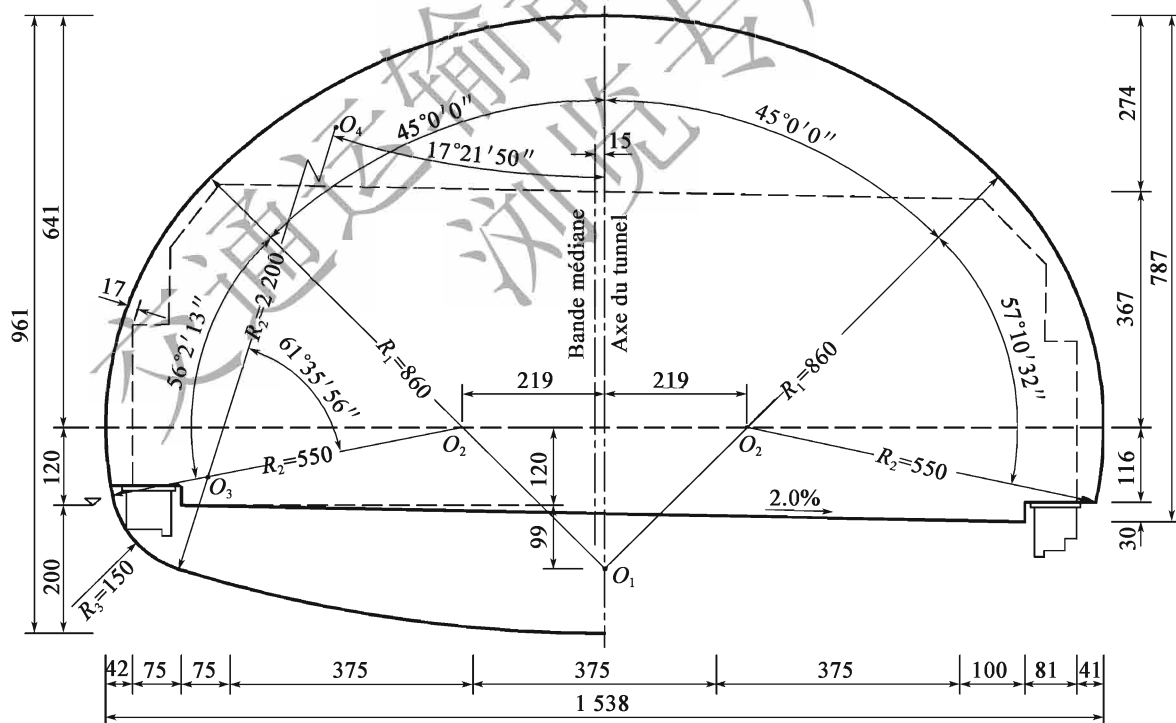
Gabarit du tunnel autoroutier et du tunnel routier de première classe à trois voies (100km/h) (unité: cm)
